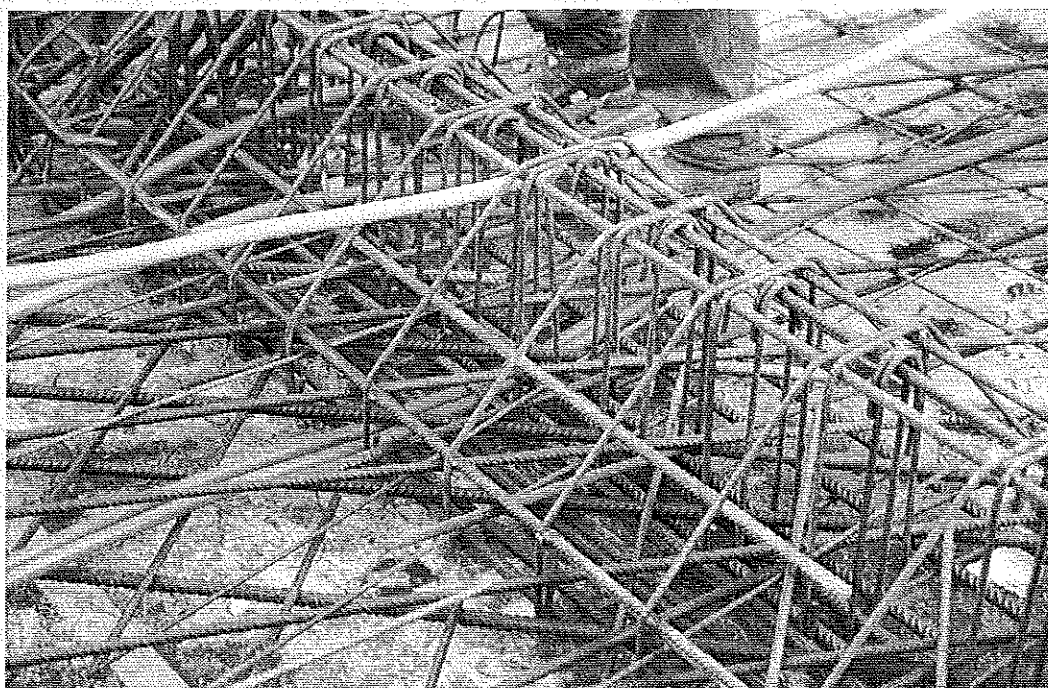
La présence d'une poutre en allège et des armatures principales biaisées n'a pas facilité le travail des uns et des autres. © J. Putatti
